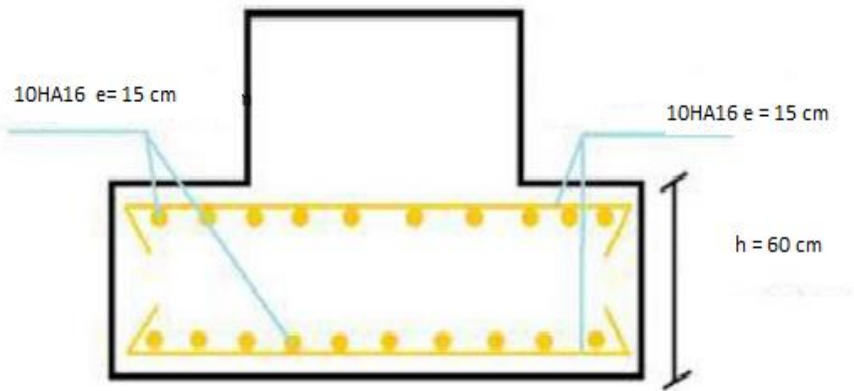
2 : vue du ferrailage des semelles isolées
